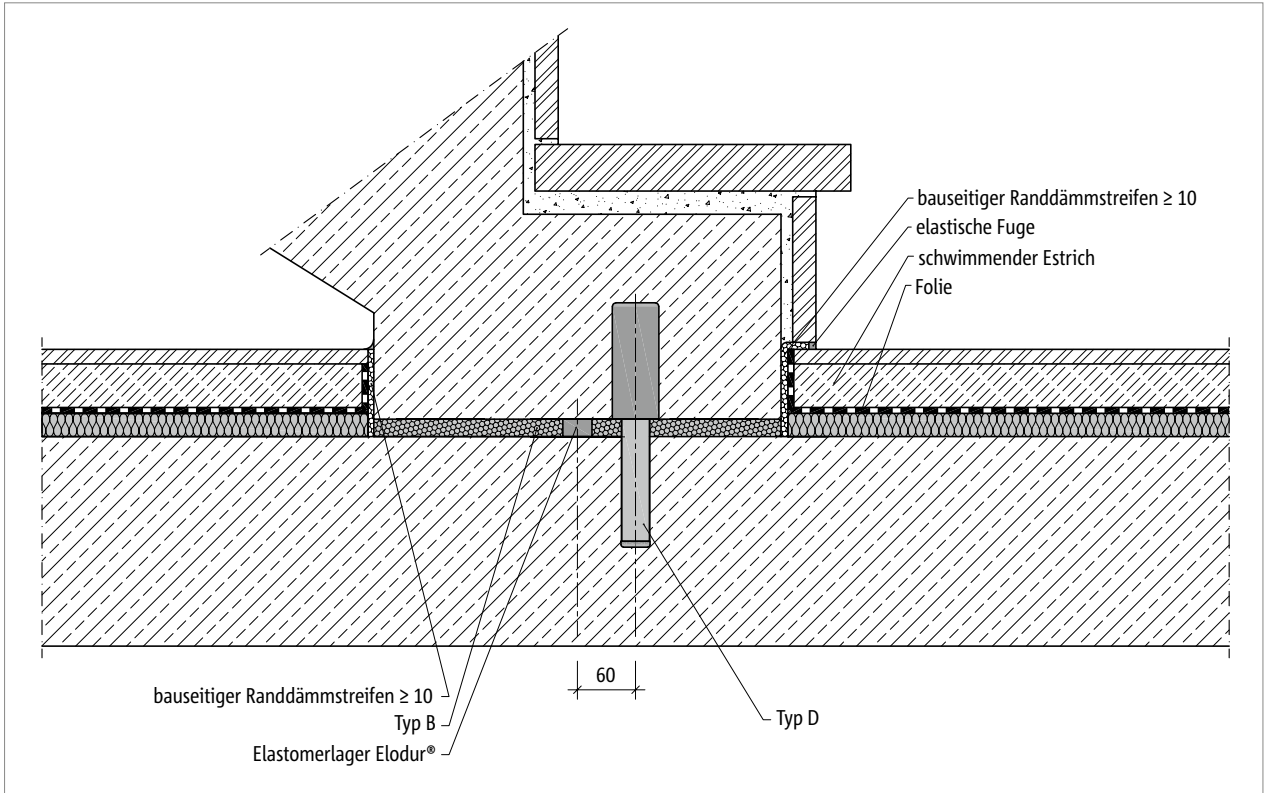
Schöck Tronsole® Typ B + Typ D: Einbauschnitt
